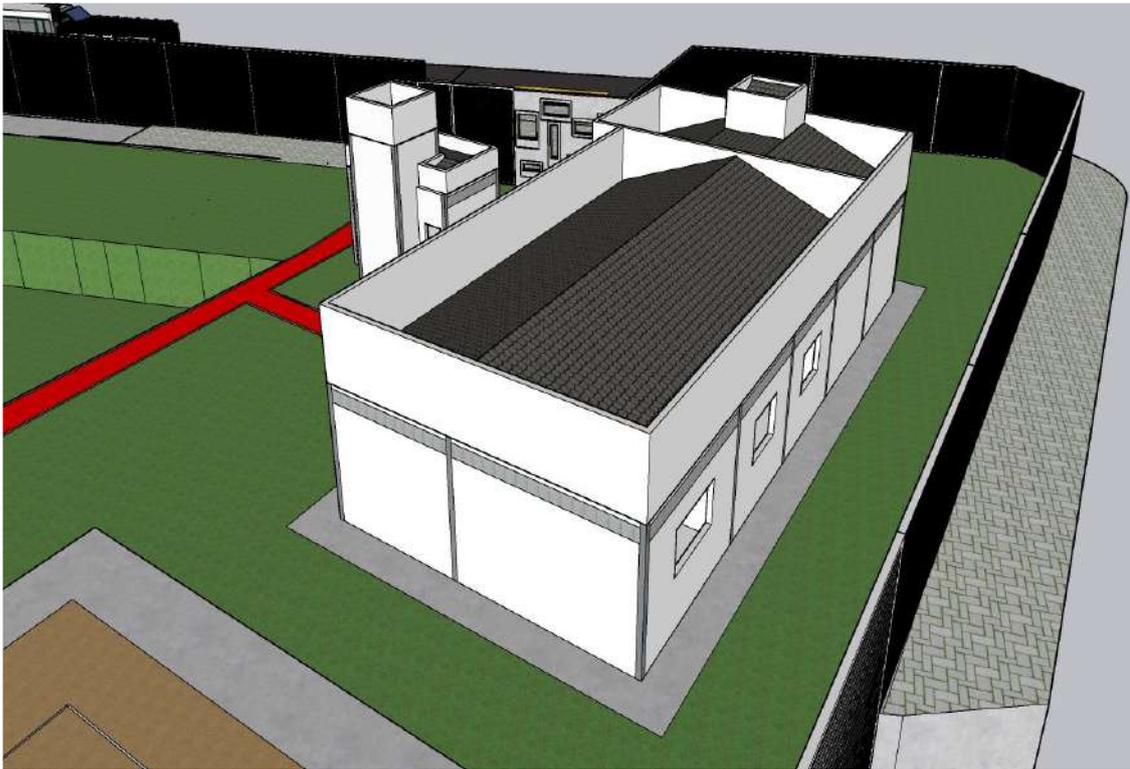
Representação de pilares e vigas das salas de animação e guarita
